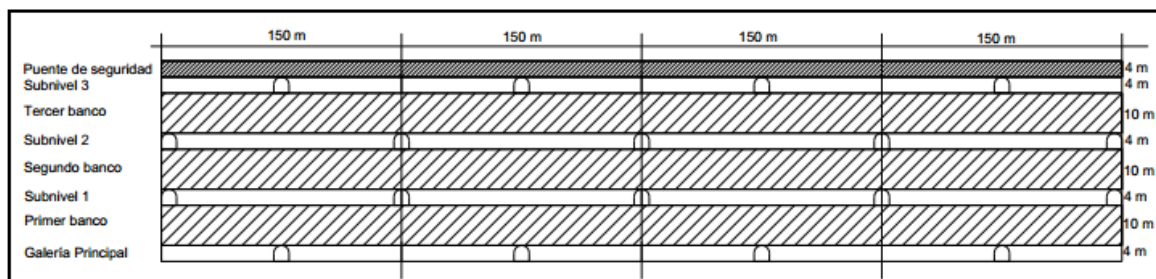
Esquema típico de un block de minado por Bench and Fill (avoca).
